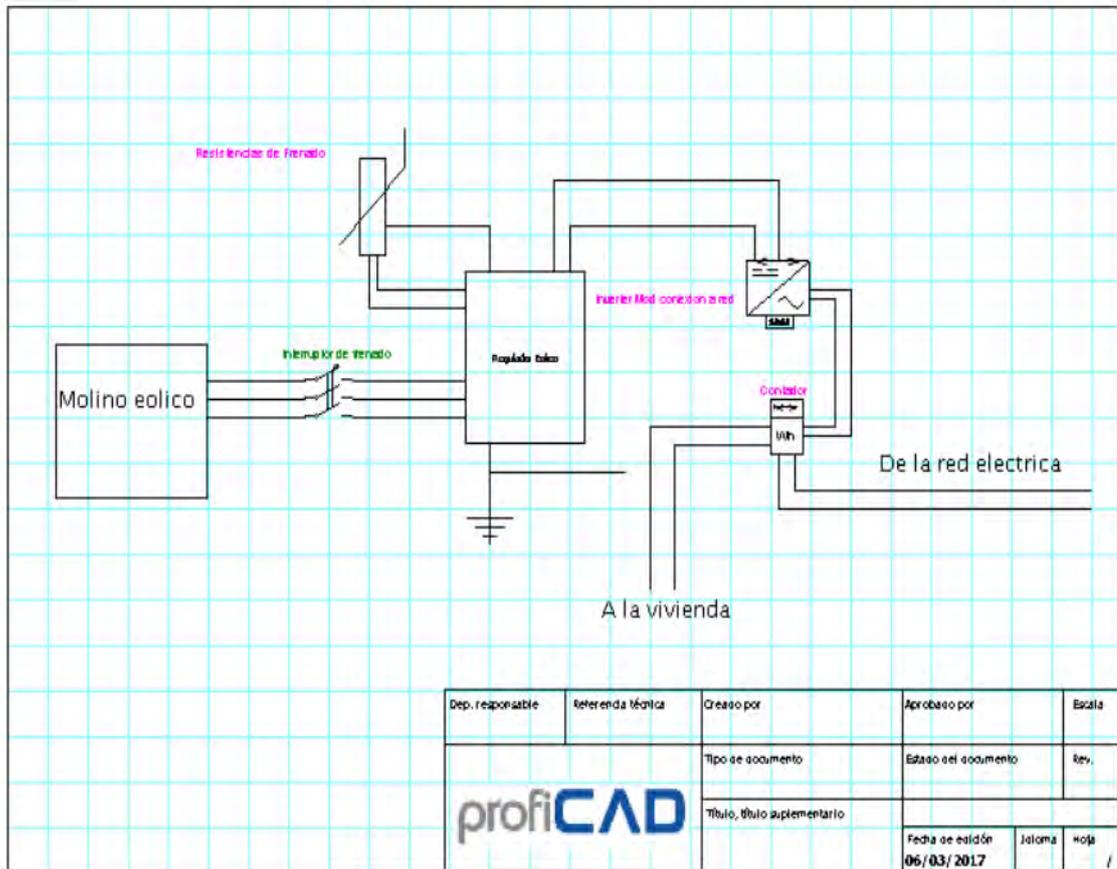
Esquema eléctrico detallado. Fuente Elaboración propia
